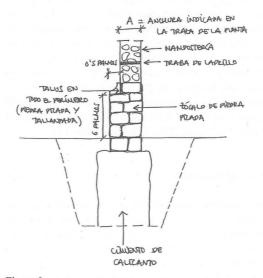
Muro perimetral de la iglesia parroquial de Moncofa (dibujo de la autora 2013)
